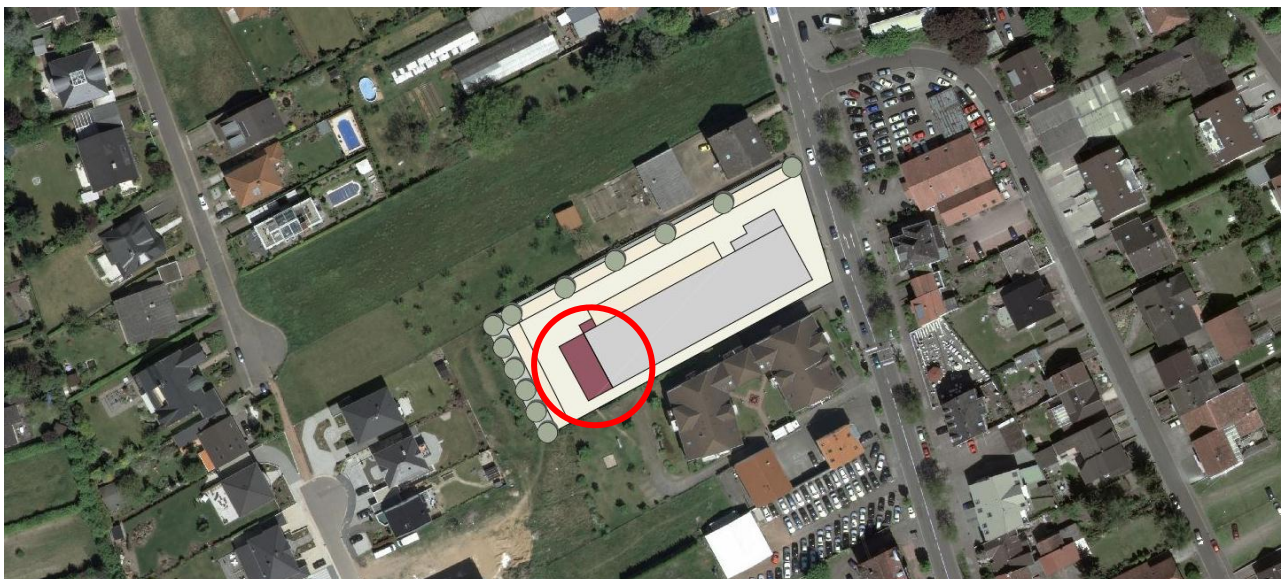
Einbindung des REWE-Marktes mit geplanter Erweiterung in das Luftbild (Eigene Darstellung, ISU 2011)
